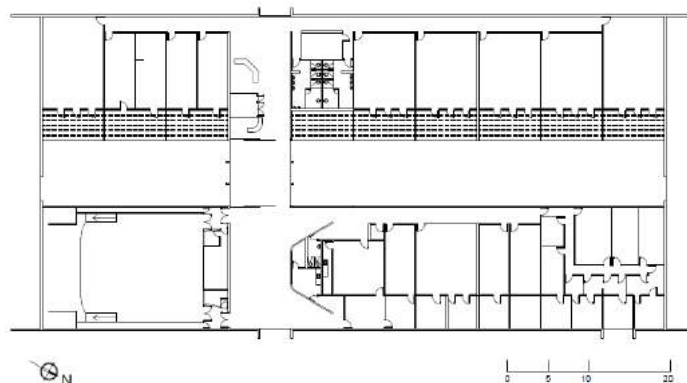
FE5, planta baixa. Fonte: Prefeitura do *campus* (adaptado por Christine Lucas).
